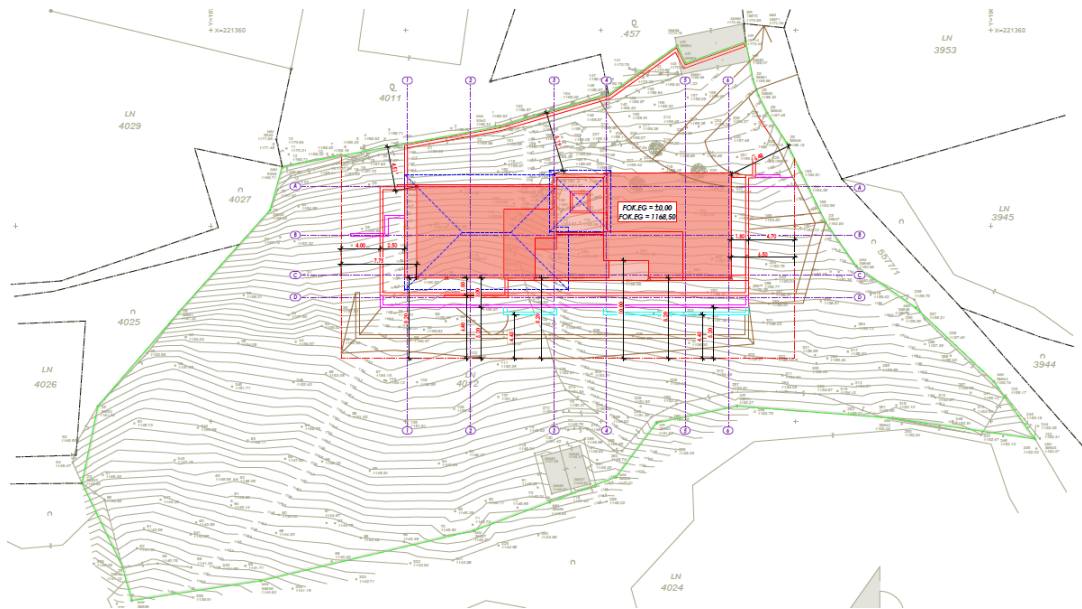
Teilungsvorschlag mit Lageplan des geplanten Bauvorhabens auf einer Teilfläche der Gp. 4012 mit der Projektnummer 20-42 und dem Plandatum 21.12.2021(ohne Maßstab)
